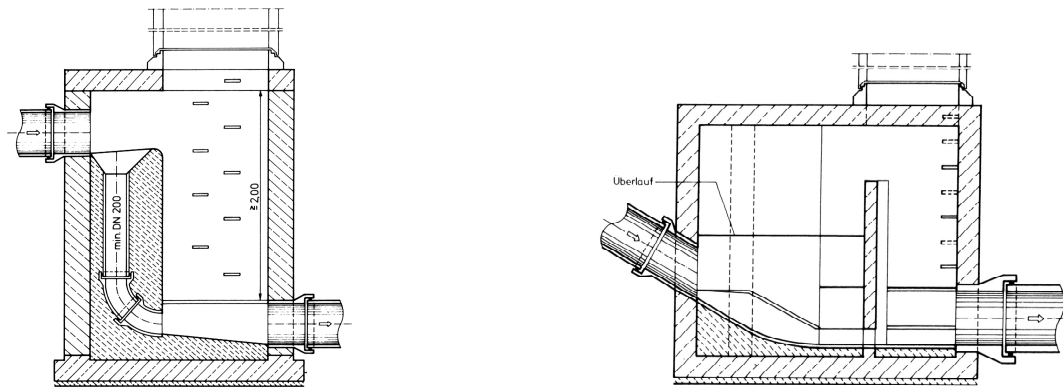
Seitenansicht eines Absturzbauwerks mit innen liegendem Untersturz sowie einer Steilstrecke (ATV, 1996)
